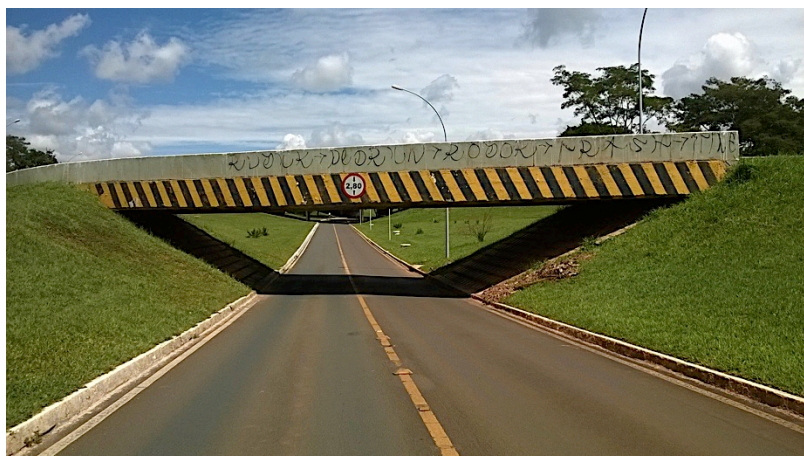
Vista lateral da OAE-18, superestrutura em laje de concreto.
